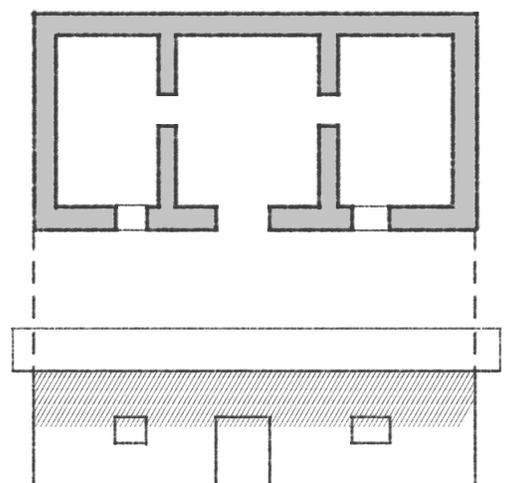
Regularidad en planta y elevación. Elaboración propia.
